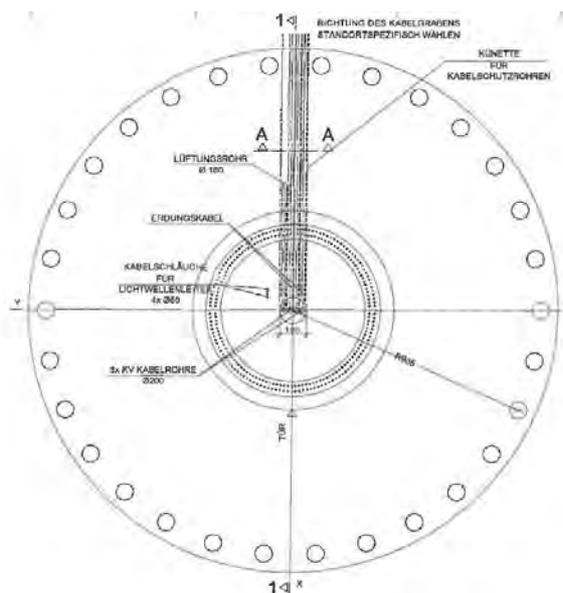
Grundriss der Tiefgründung ohne Auftrieb des Anlagentyps Vestas V150 4.0/4.2 MW, MK3E, WZ2GK(S) 166 m
